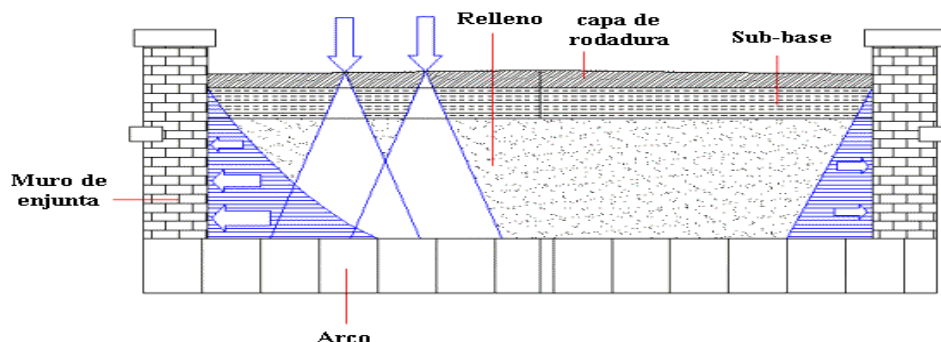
Sección transversal de un puente de mampostería en arco, con efecto de cargas.
